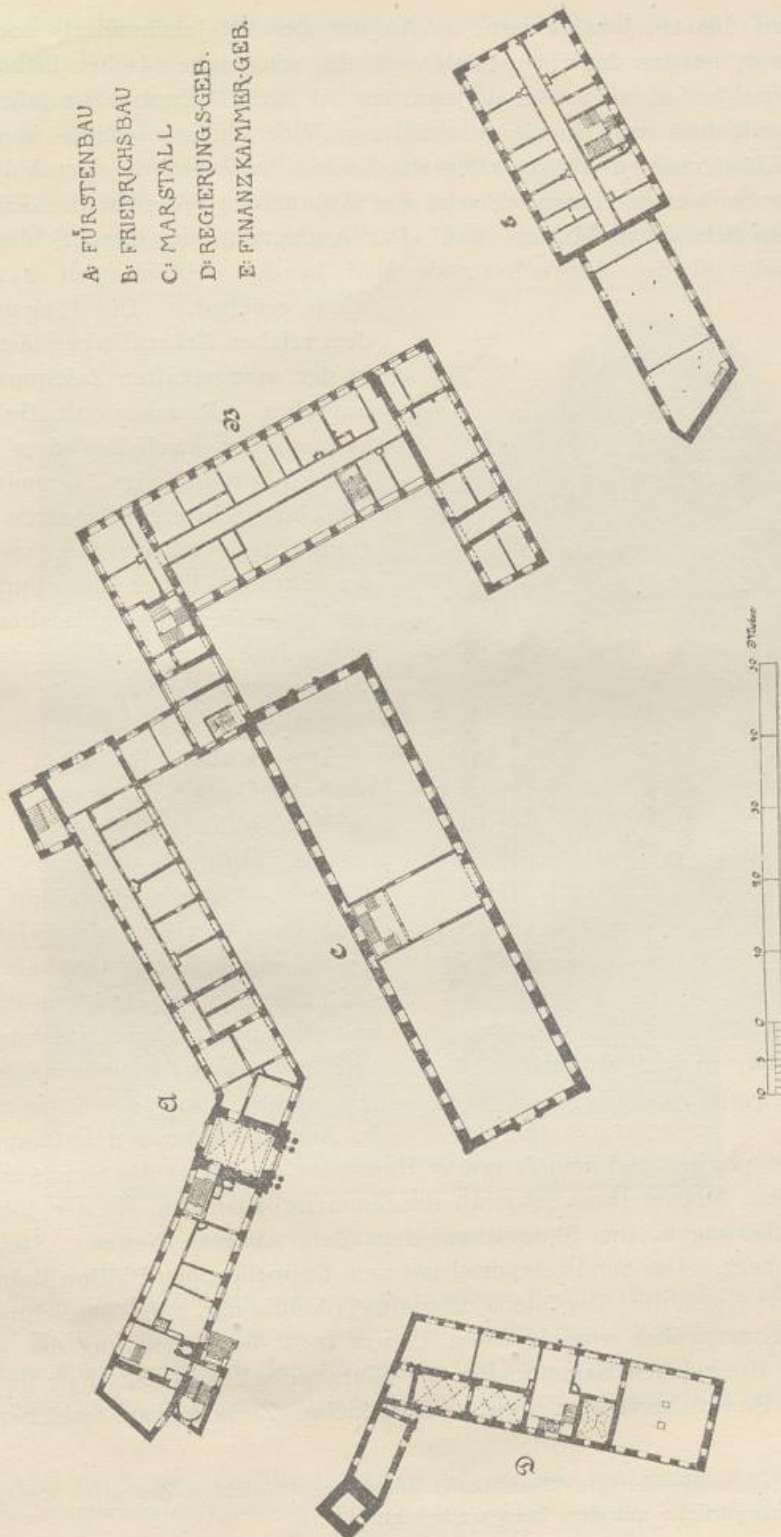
Gegenwärtiger Grundriss des Schlosses.
